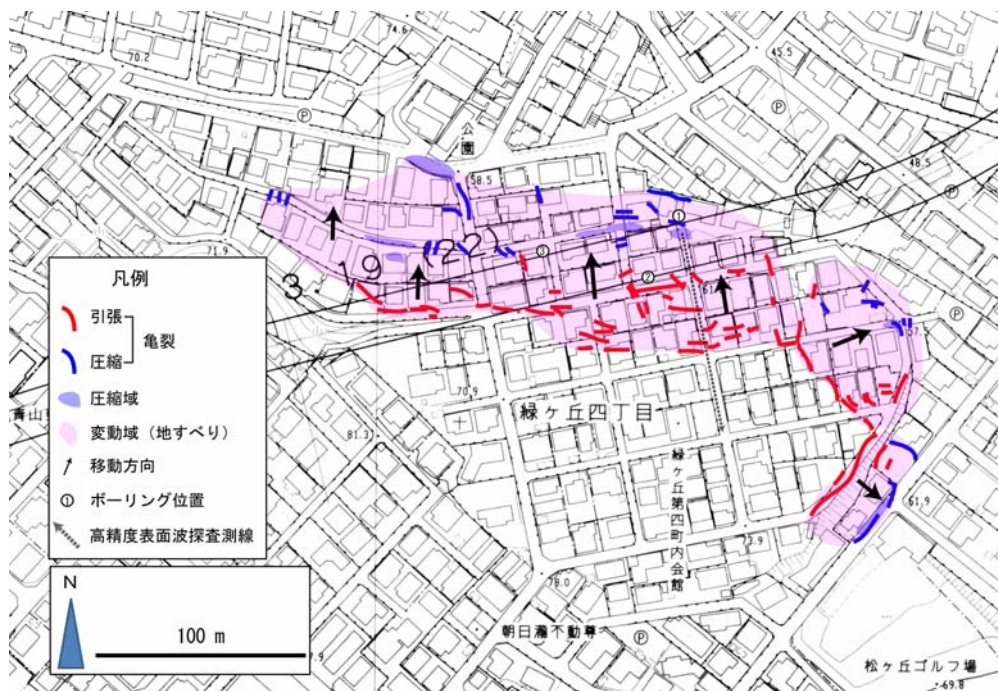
緑ヶ丘4丁目地すべり（腹付け盛土）の平面図
